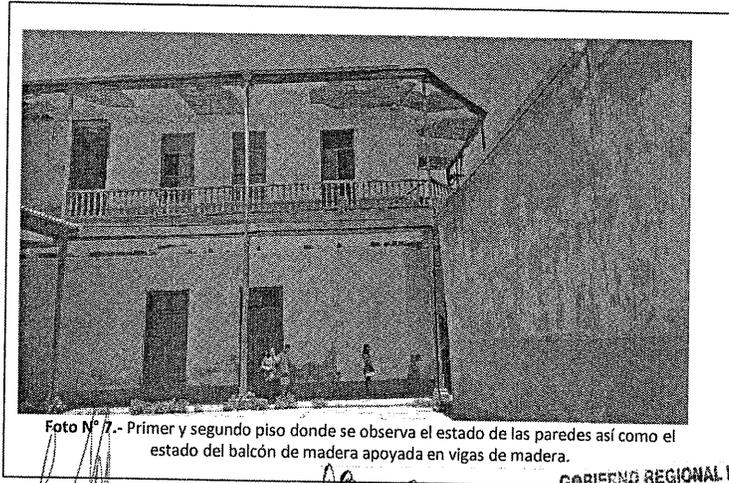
Primer y segundo piso donde se observa el estado de las paredes así como el estado del balcón de madera apoyada en vigas de madera.
